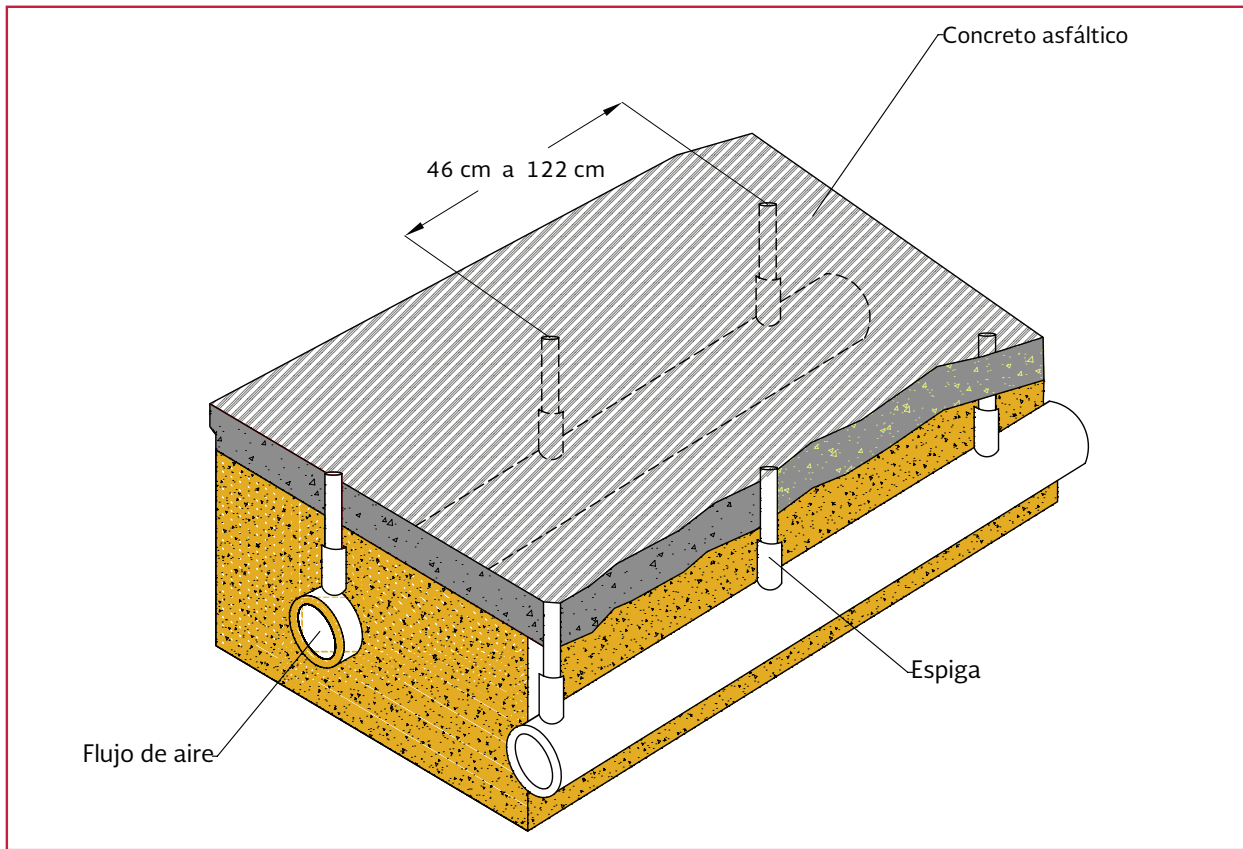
Tuberías perforadas sobre la base de concreto
